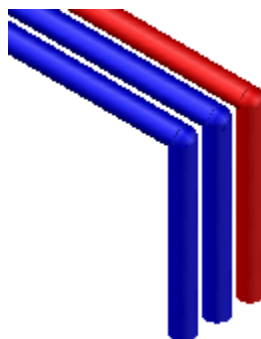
Líneas de tubería a batería de FM-200 de estribor
